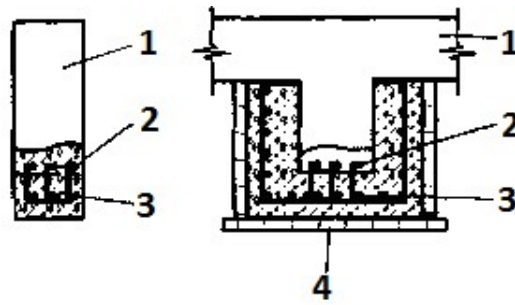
Конструктивна схема підсилення залізобетонних пустотних плит
